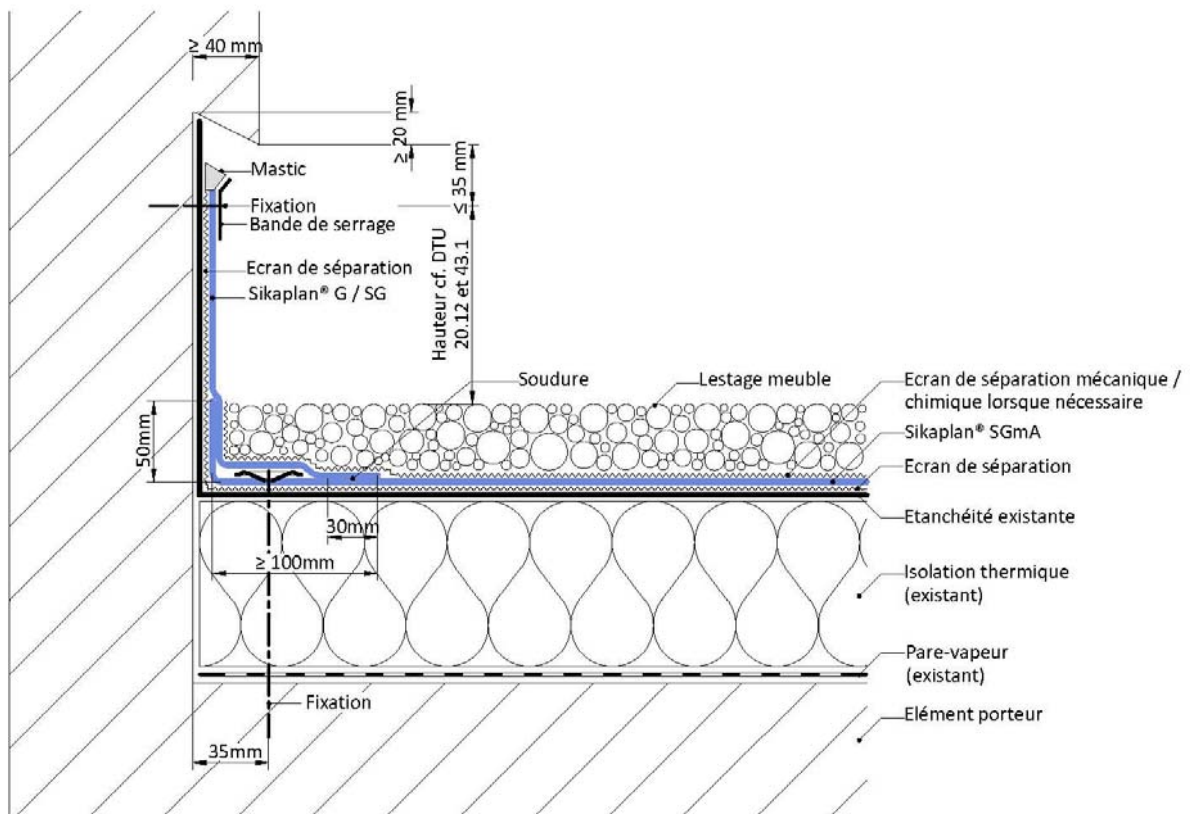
Relevé d'étanchéité sous engravure – Travaux de réfection sur maçonnerie
